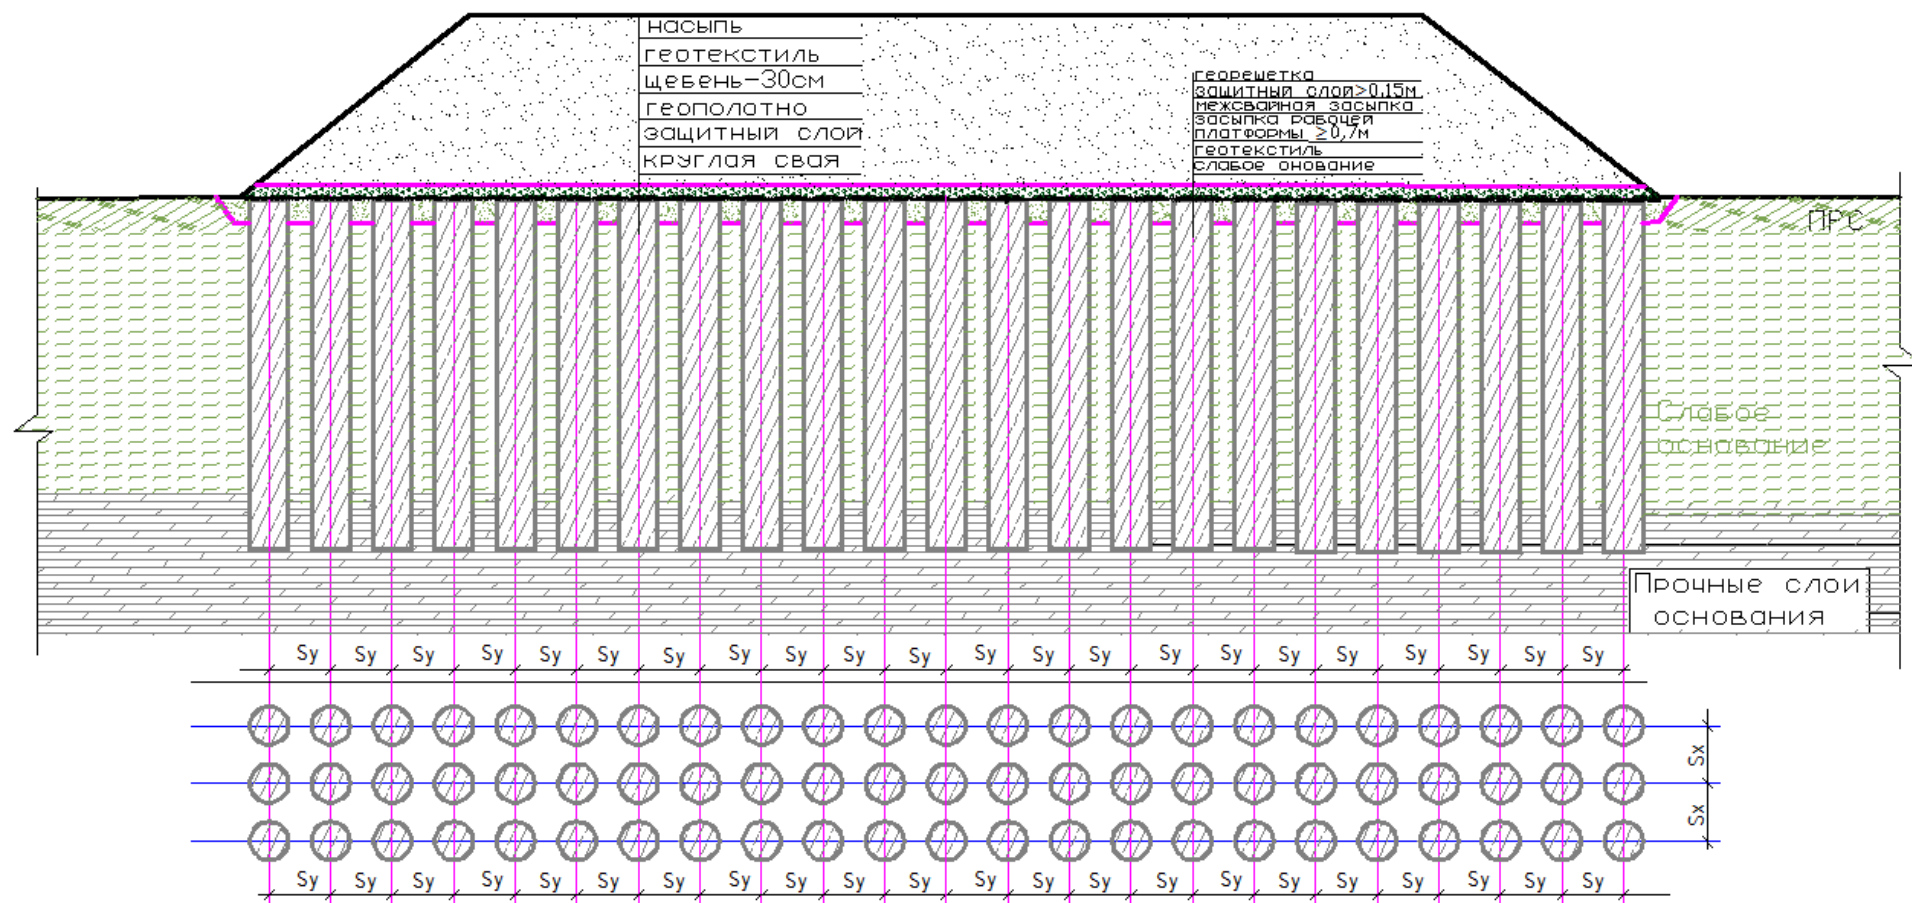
Гибкий ростверк из одного слоя геополотна с песком на круглых сваях (с размещением свай по квадратной сетке)
